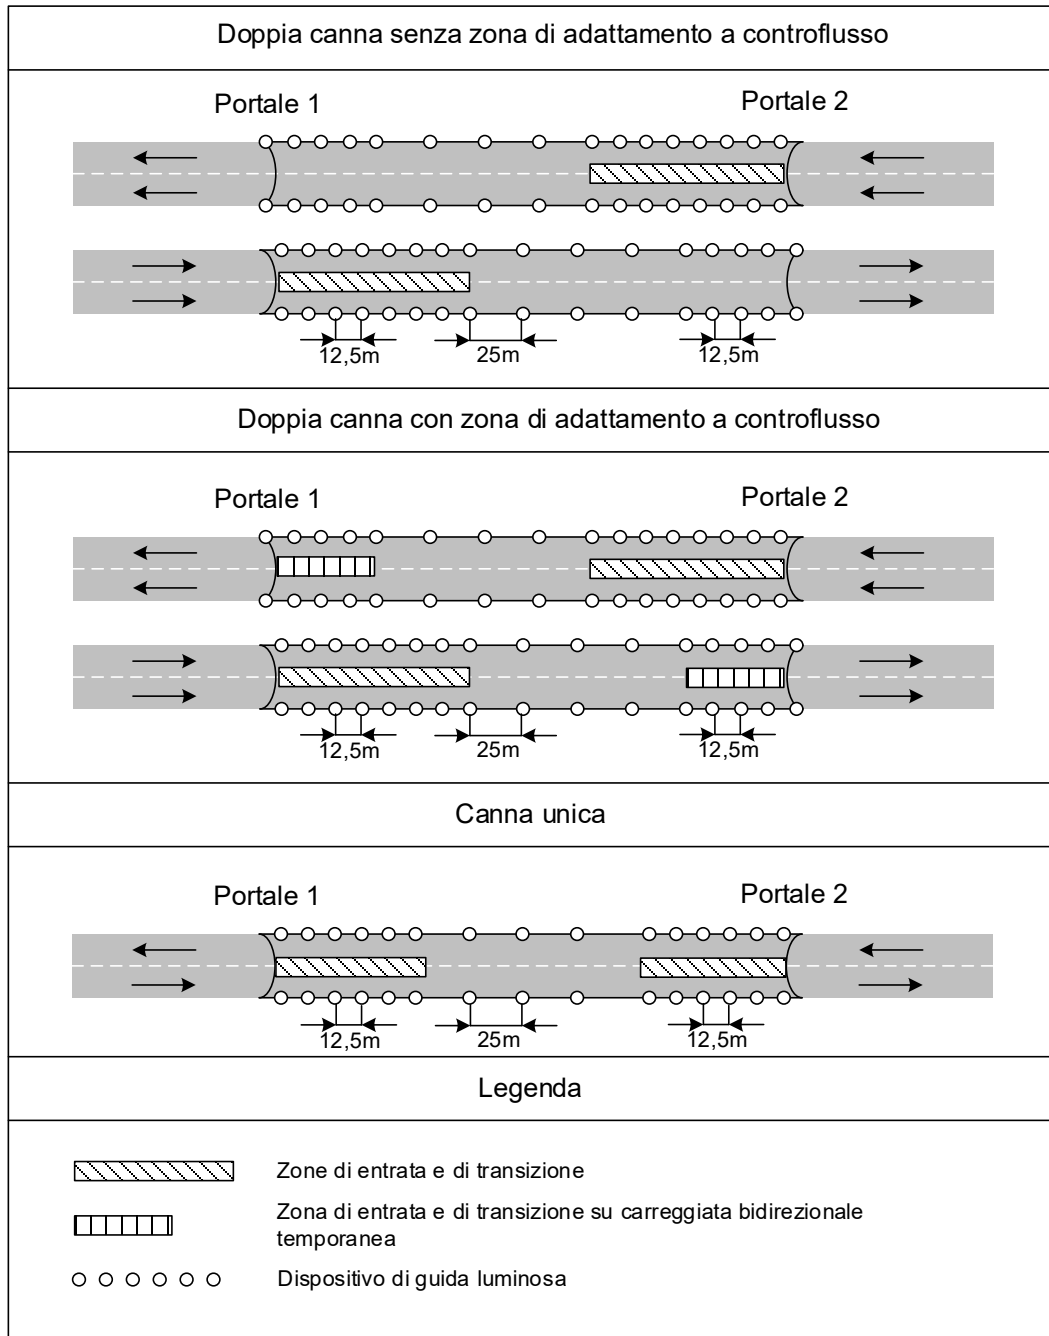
Disposizione dell'impianto del dispositivo di guida luminosa in funzione della configurazione della galleria
